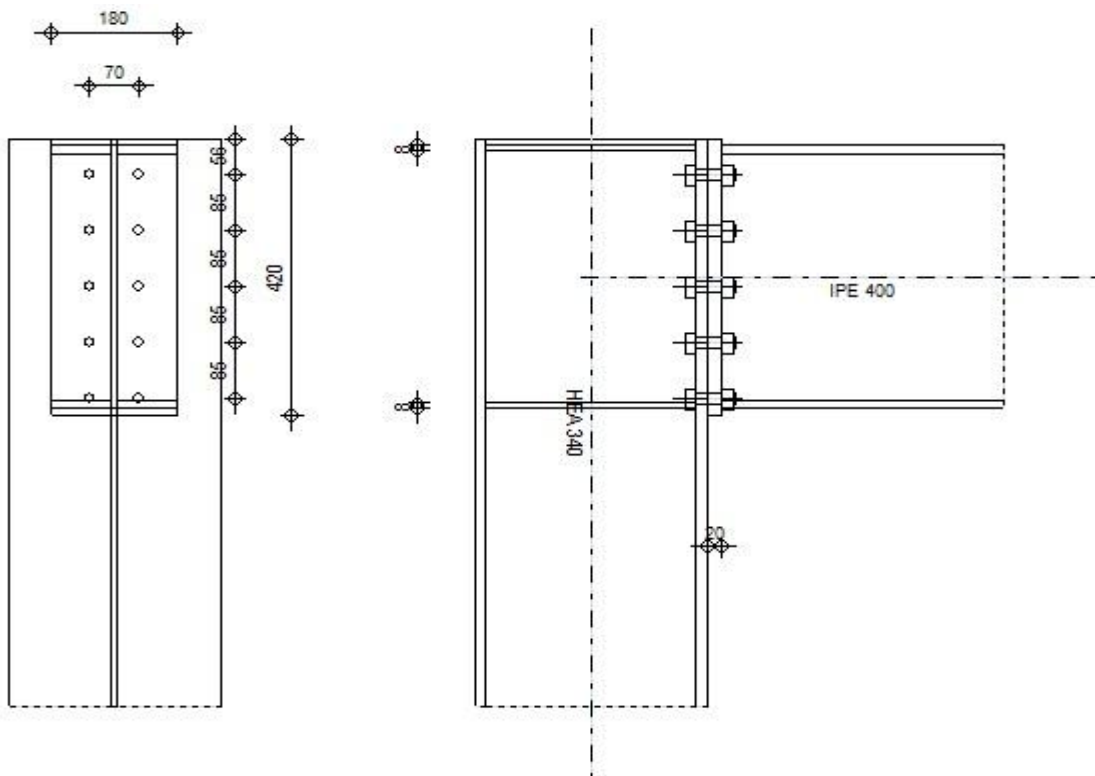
Détail sur l'assemblage poutre-poteau
